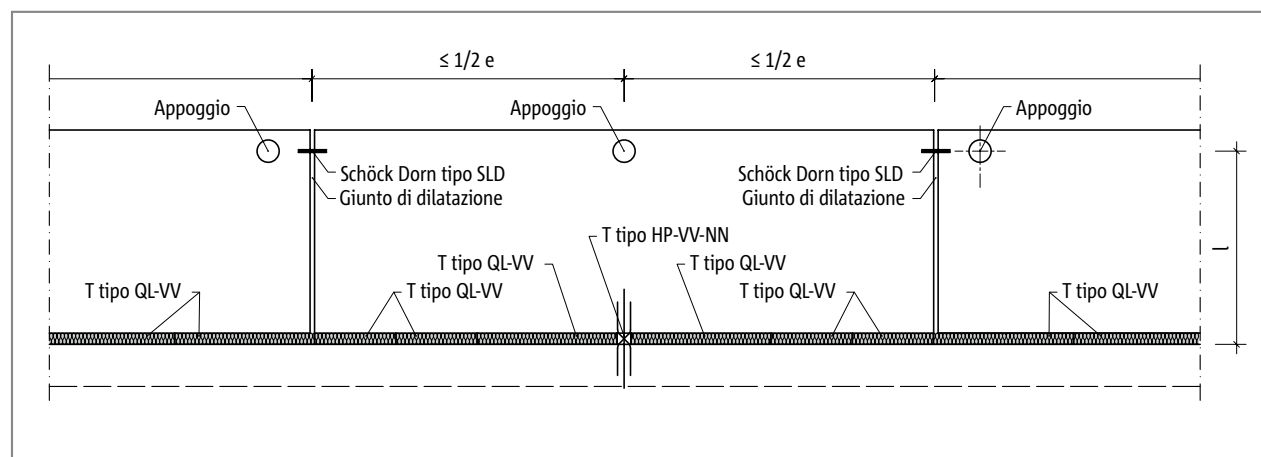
Schöck Isokorb® T tipo HP: disposizione dei giunti di dilatazione
